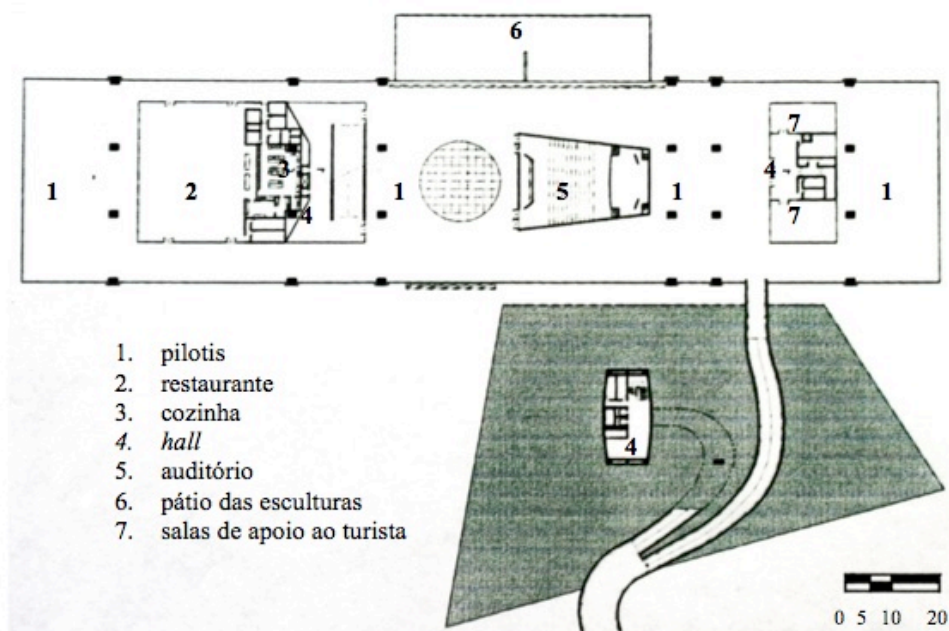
Museu Oscar Niemeyer – planta baixa pilotis
